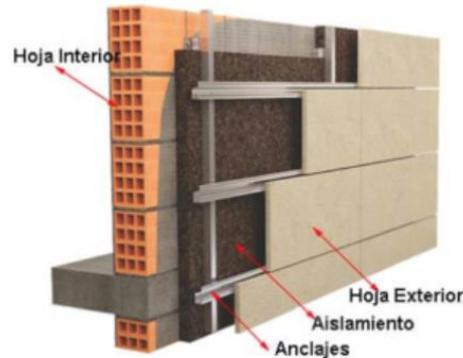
Sistema de fachada ventilada (Retek, 2023).
